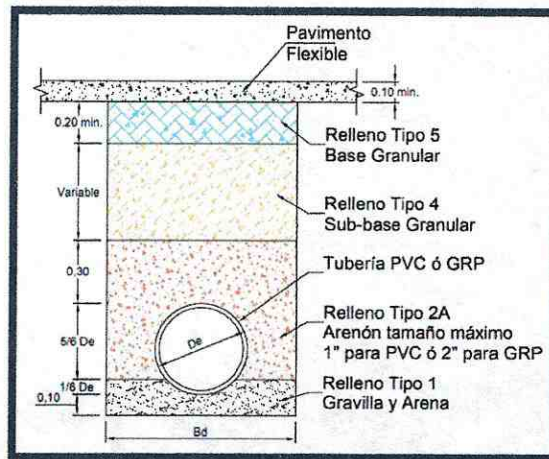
Cimentación típica de tubería para vías de pavimento flexible
